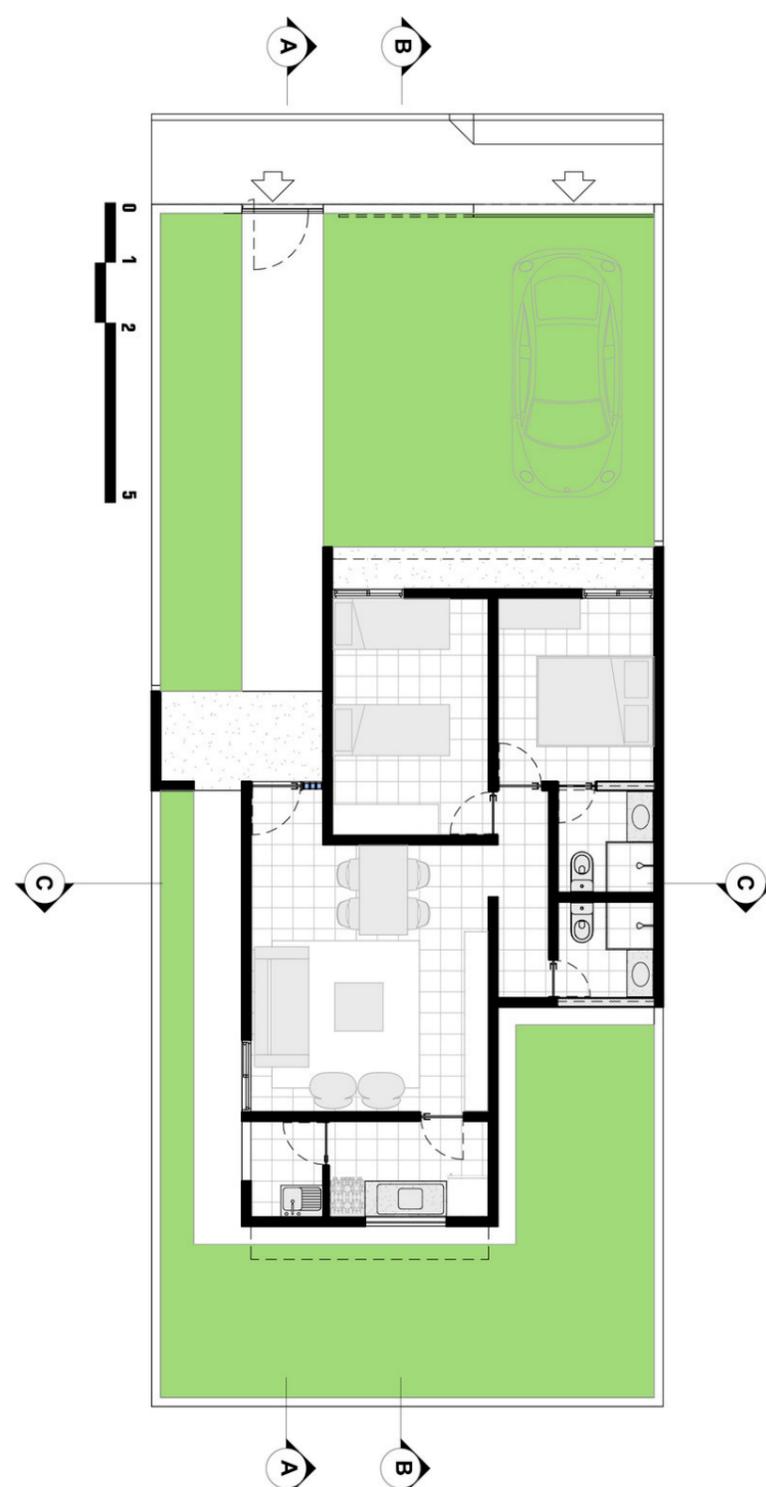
PLANTA OPÇÃO COM 2 QUARTOS, SENDO
